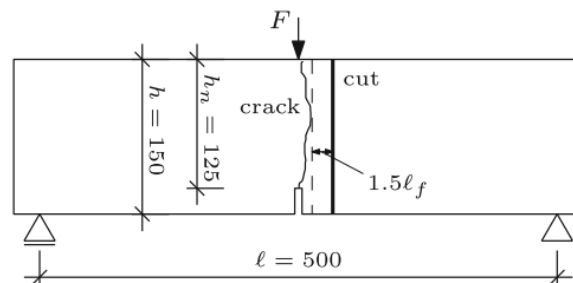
Distance du plan de coupe pour l'analyse de l'orientation des fibres (Wille et al., 2014)
